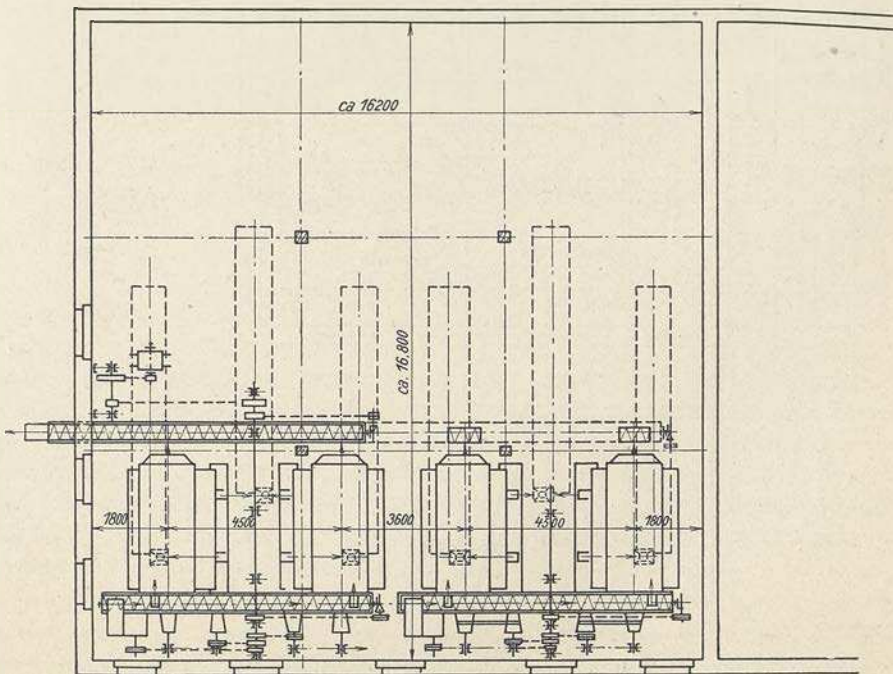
Grundriß der Erbsen-Spezialfabrik. (I. Stockwerk.)
